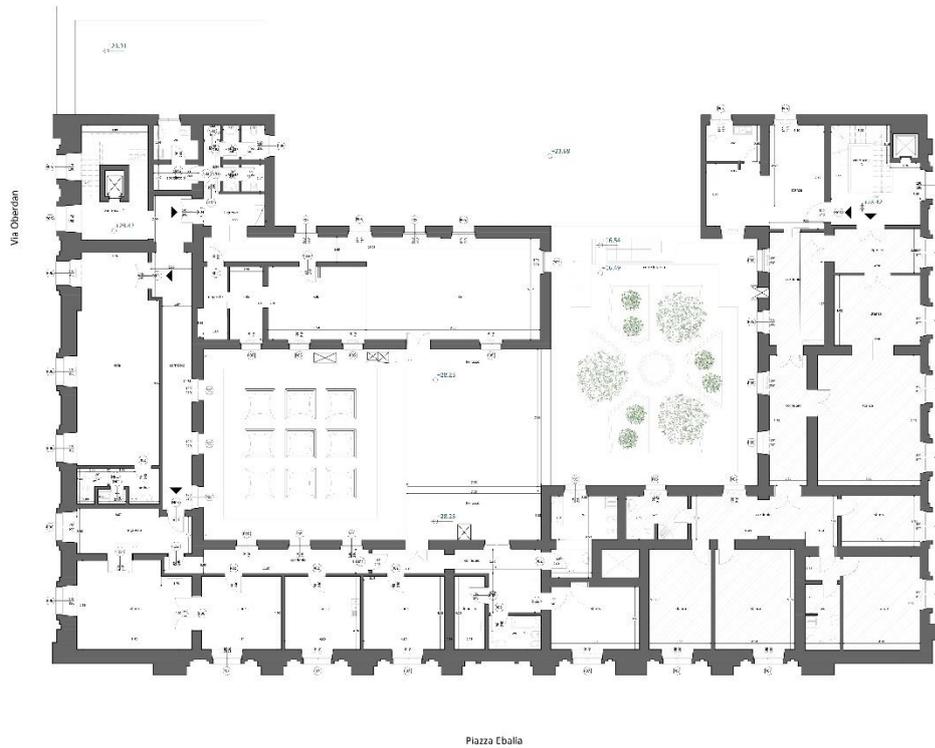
Pianta piano secondo. Rilievo architettonico a cura dell'Ing. Giorgio Tonti.
